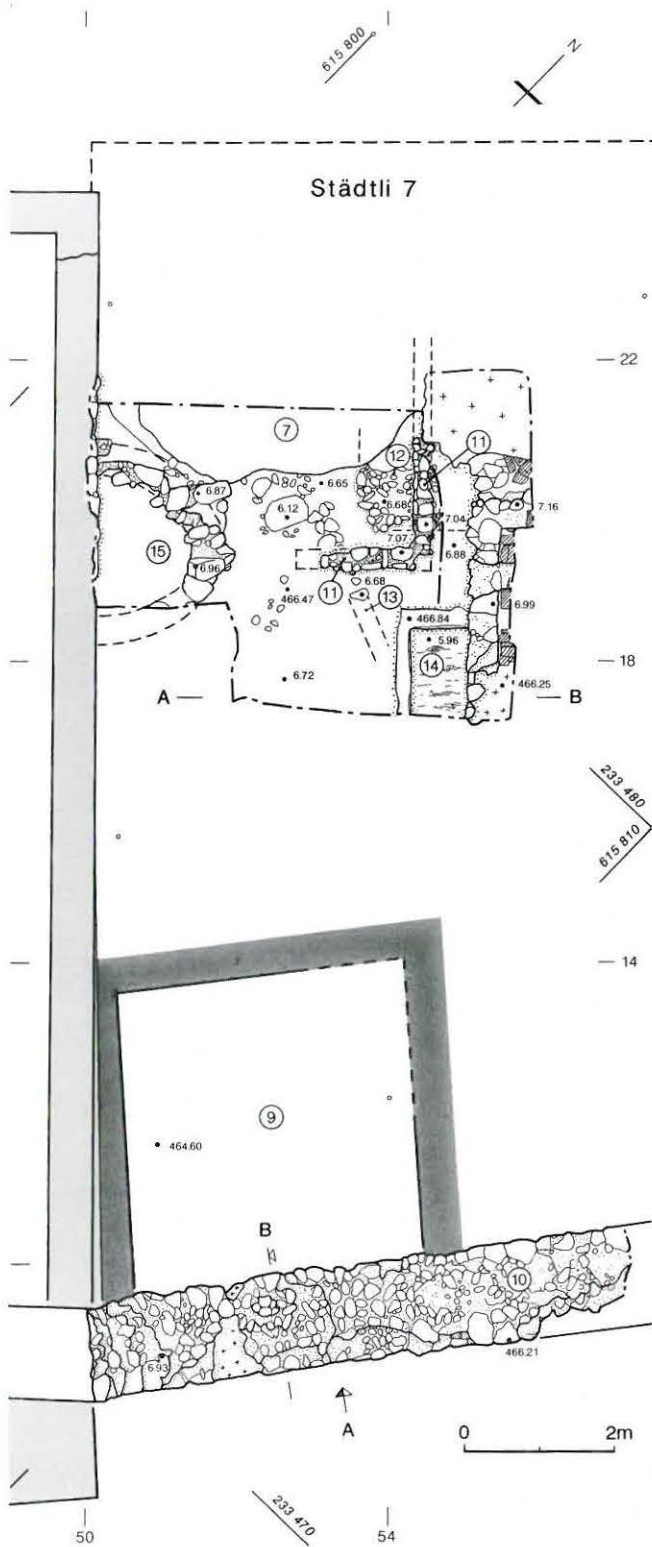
Grundriss der mittleren Strukturen. M. 1:100. 11 Steinreihe unter Wandschwelle, 12 ältere Pflasterung, 13 Kanälchen, 14 gemauerte neuzeitliche Kloakengrube anstelle einer Vorgängerin, 15 kreisförmiges Fundament, wohl Backofen.
